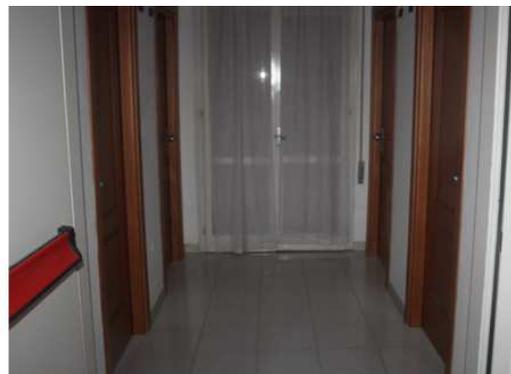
47: corridoio distributivo centrale piano terzo – scorcio della porta tagliafuoco
